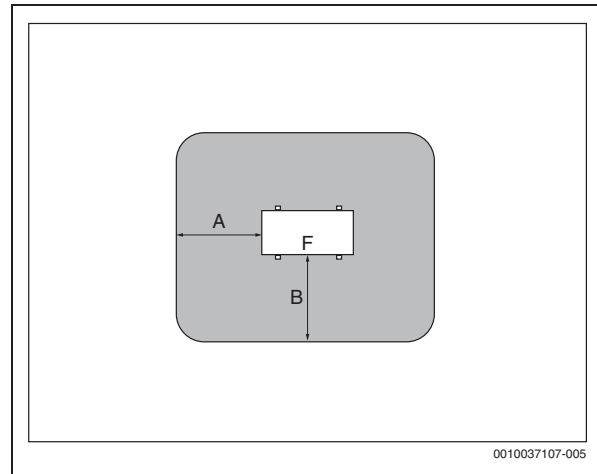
Schutzbereich bei Aufstellung auf dem Boden, auf dem Grundstück oder Dach
